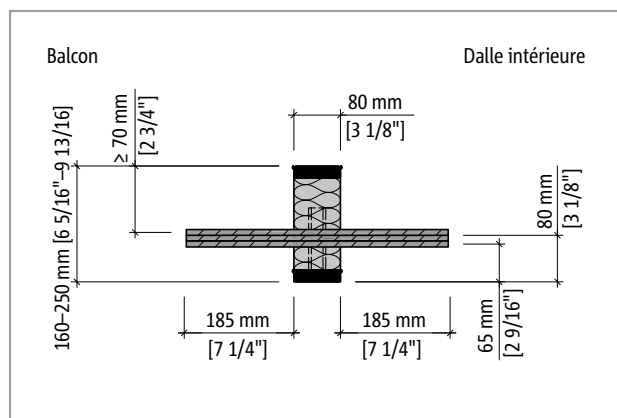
Schöck Isokorb® T Type CH-VV1-NN1 : coupe transversale du produit
